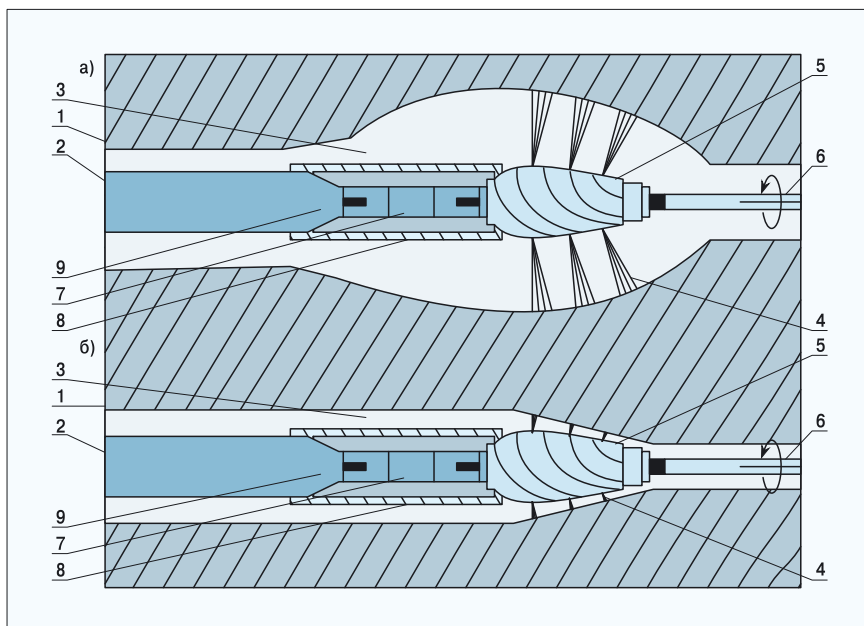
Горизонтальное направленное бурение с расширением скважины (а — чрезмерным; б — малым; 1 — грунтовой массив; 2 — полиэтиленовая труба; 3 — чрезмерная полость; 4 — шламовые струи; 5 — расширитель; 6 — штанга; 7 — вертлюг; 8 — защитная труба; 9 — ниппель)
